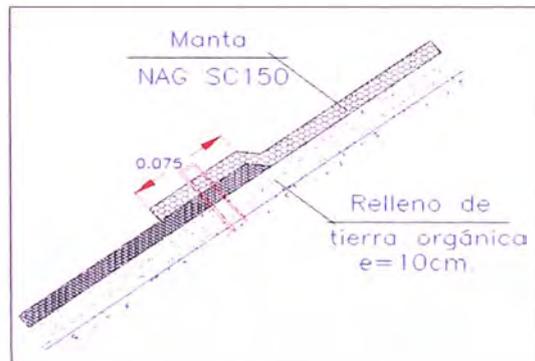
Traslape entre secciones consecutivas de biomanta NAG SC-150 en la bajada del talud.
